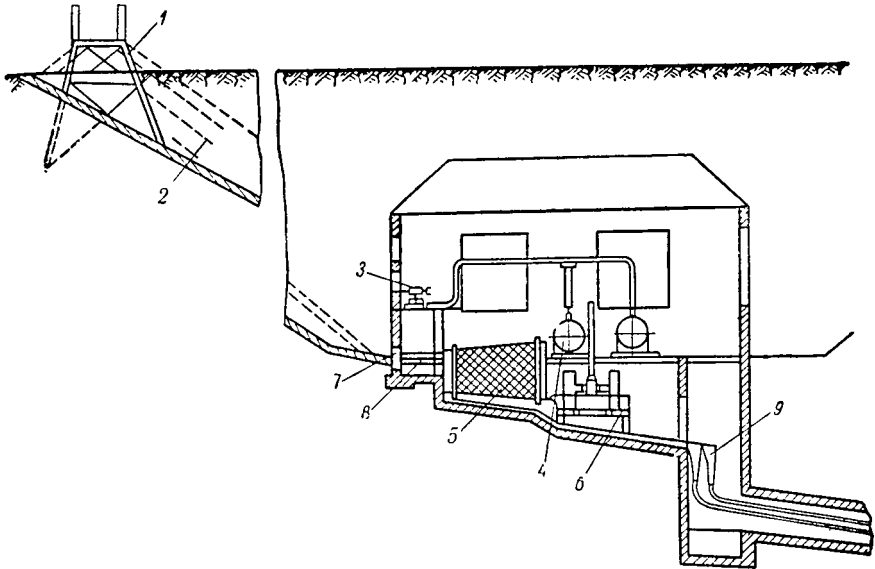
Поверхностная смесительная установка для гидрозакладки
